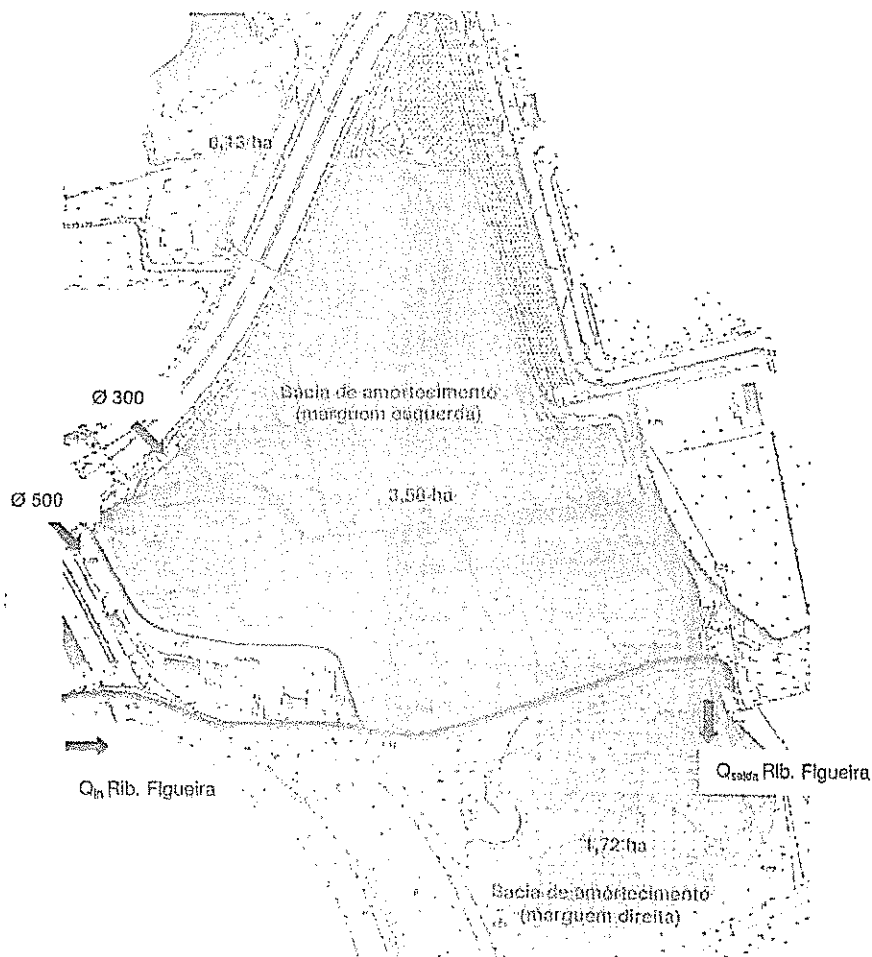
| Área de implementação da bacia de amortecimento. Entradas e saídas de caudal.
